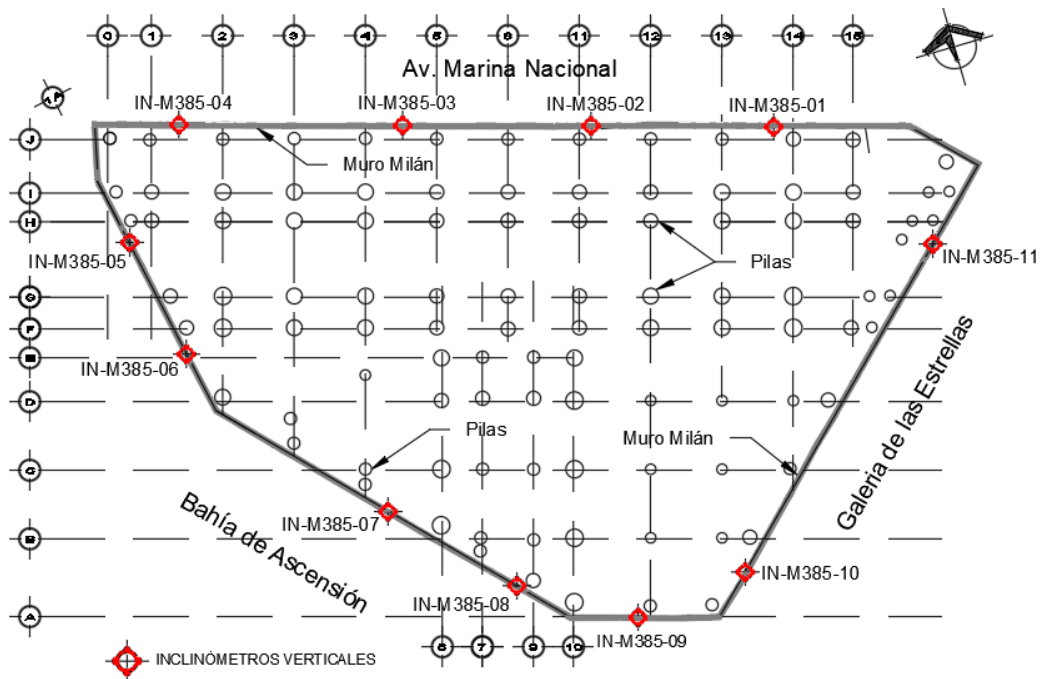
Planta de ubicación de los once inclinómetros verticales. Fuente: Elaboración propia
